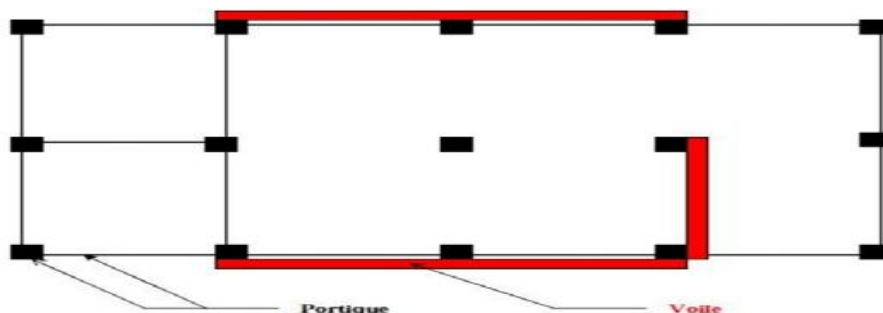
Structure mixte: voiles et portiques (Ile 2000).
